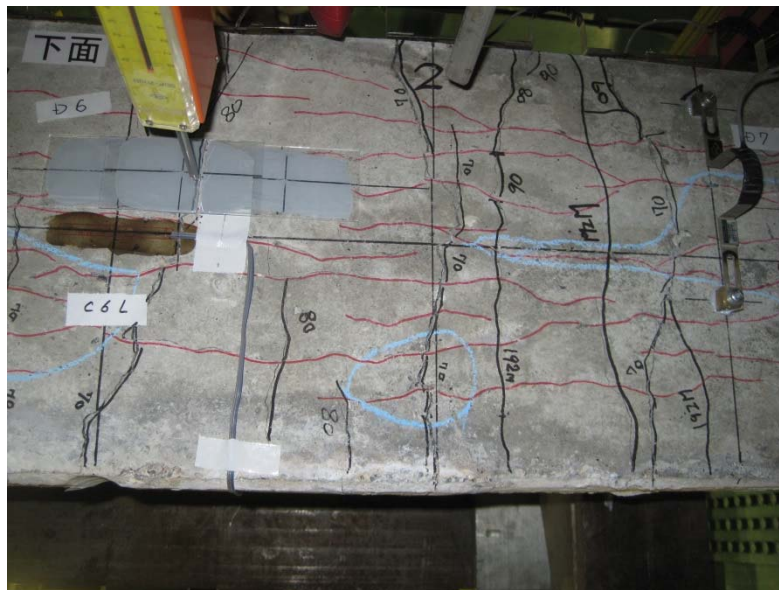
Pmax96.9kN 載荷時 G3 桁下面ひび割れ状況 (4'位置：PI-19)
